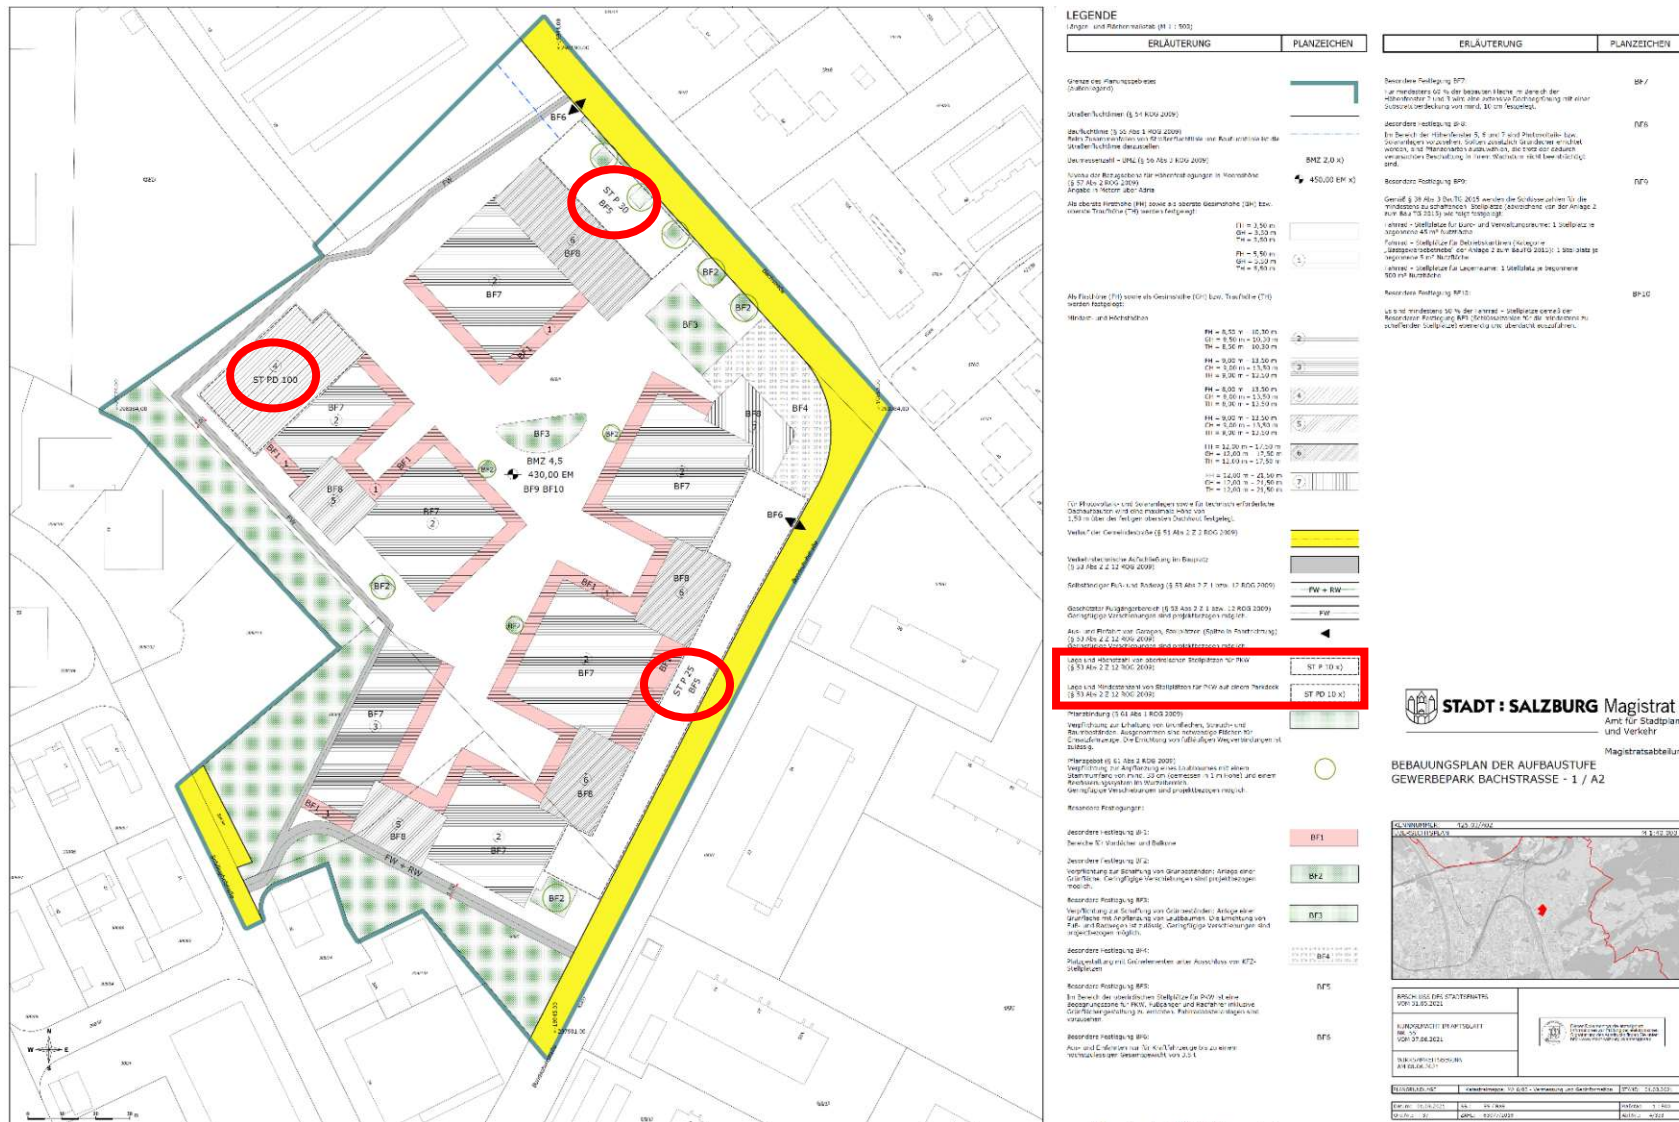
Bebauungsplan der Aufbaustufe Gewerbepark Bachstraße – 1 / A2 mit Markierung der planlich dargestellten Sammelgaragen und textlicher Festsetzung (verändert nach Stadt Salzburg 2020)
